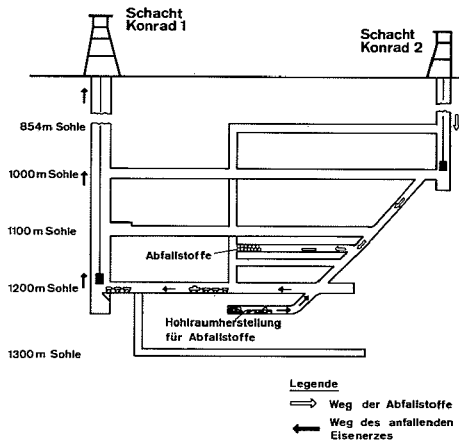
Einlagerungsablauf im Endlagerbergwerk
